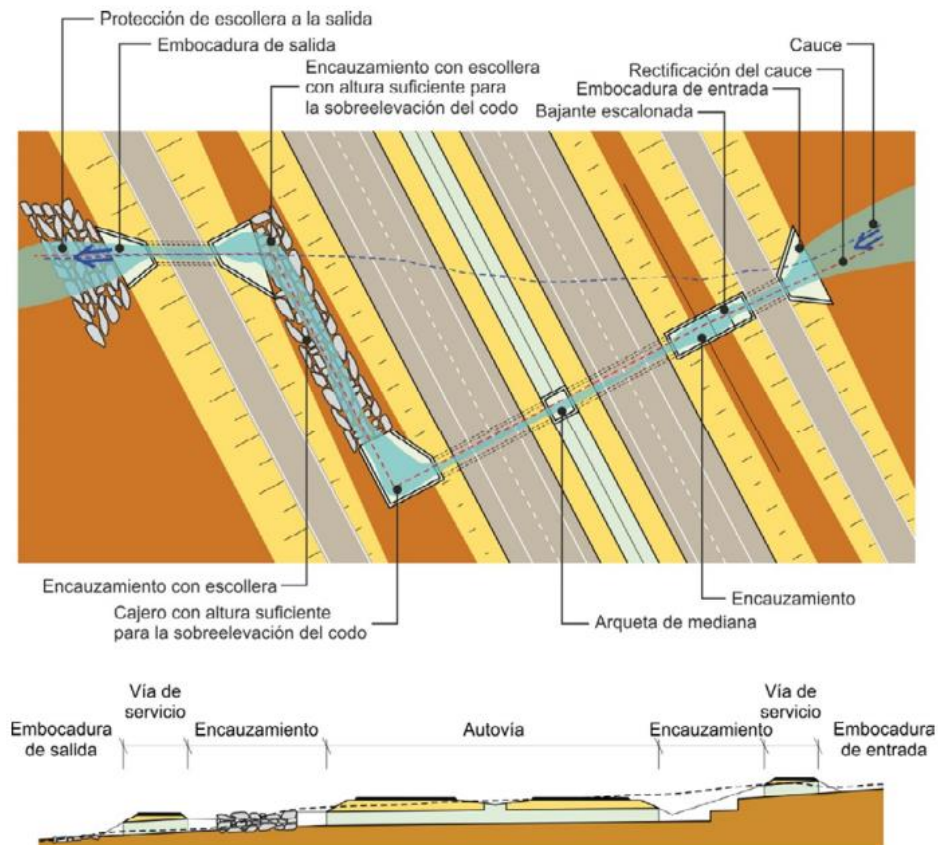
Encaje en planta de ODT. Norma 5.2-IC (MFOM, 2016).
